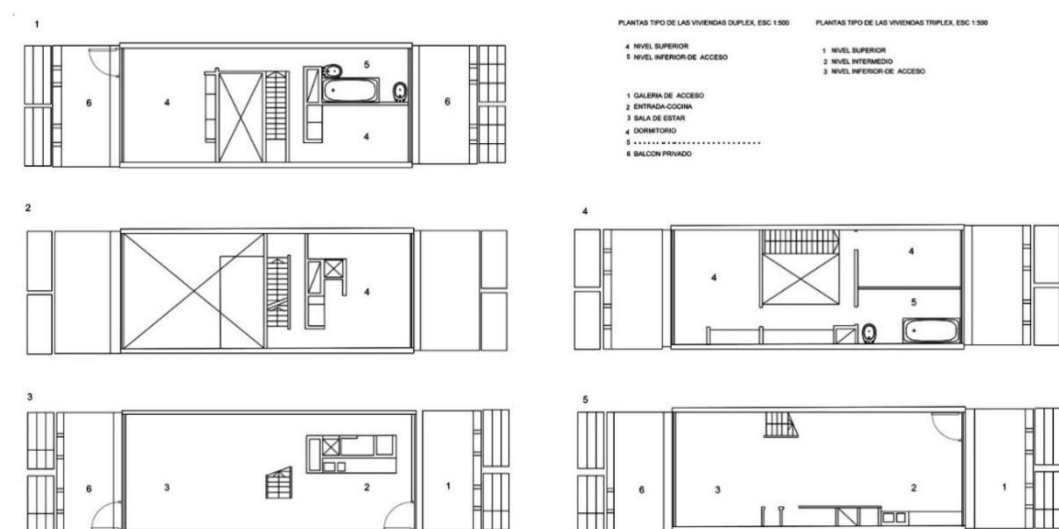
Plantas da Unidade do Projeto *Neamaus*.
